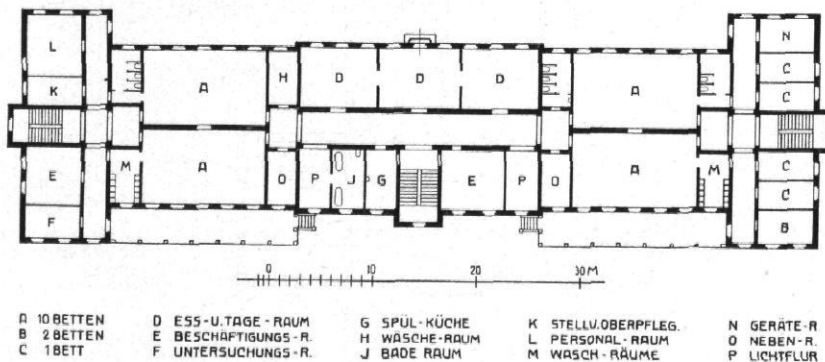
Krankenhaus C. Grundriß vom Obergeschoß
